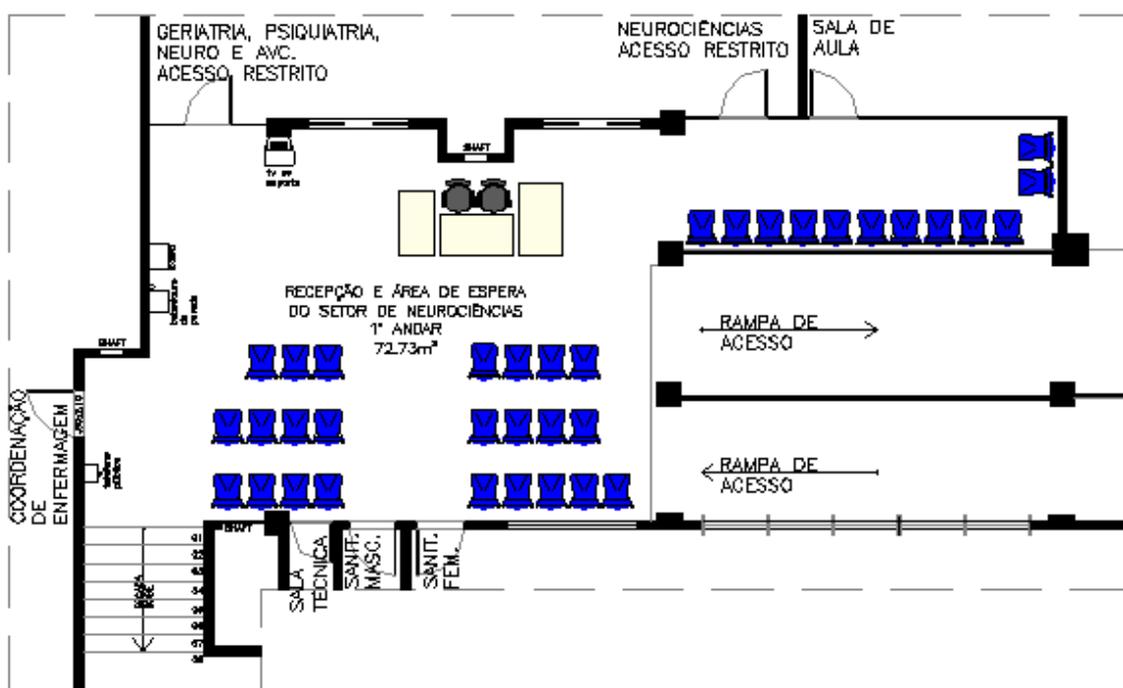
Planta baixa com layout (sem escala) da Recepção e área de espera do setor de Neurociências
